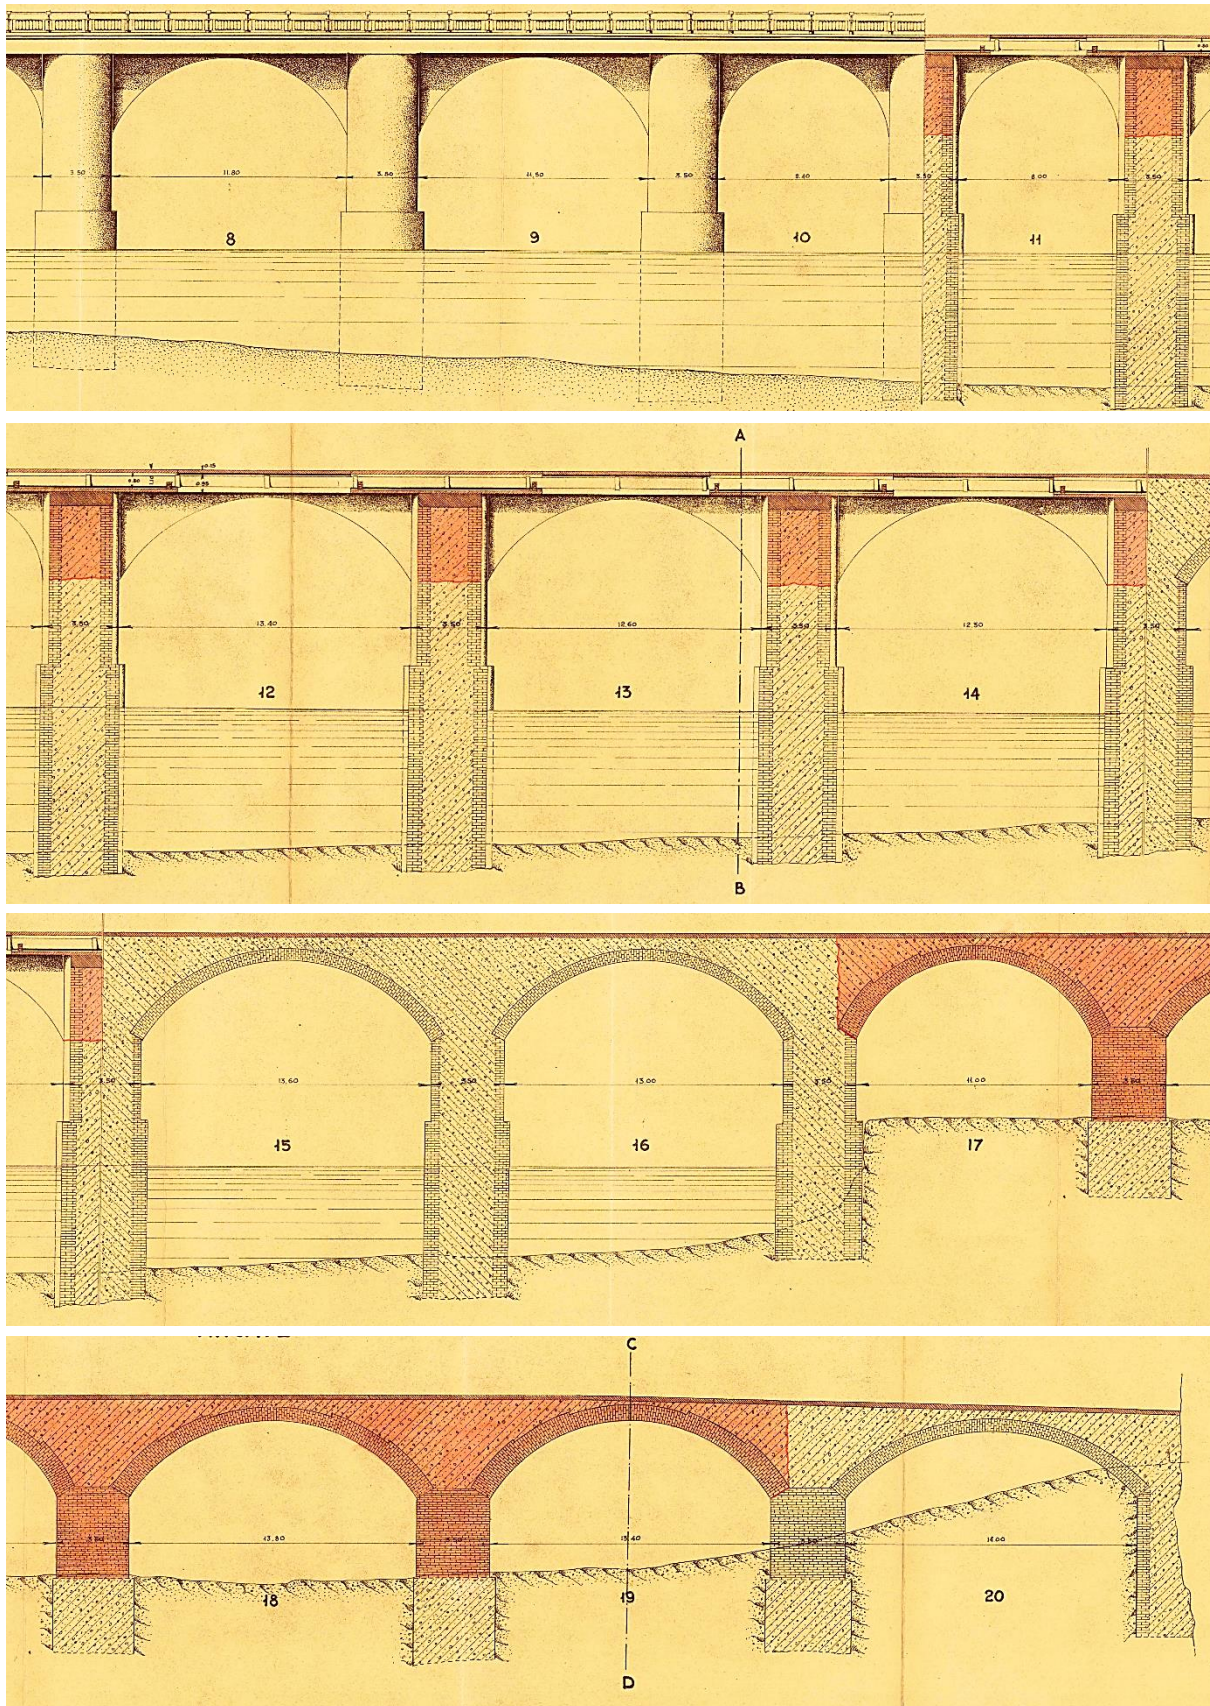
Progetto dei lavori di ricostruzione del Pontelungo – Particolari dei lavori in progetto: nuovo prospetto nord, sezione longitudinale del cunicolo dei servizi, e sezione longitudinale delle arcate. [174]
